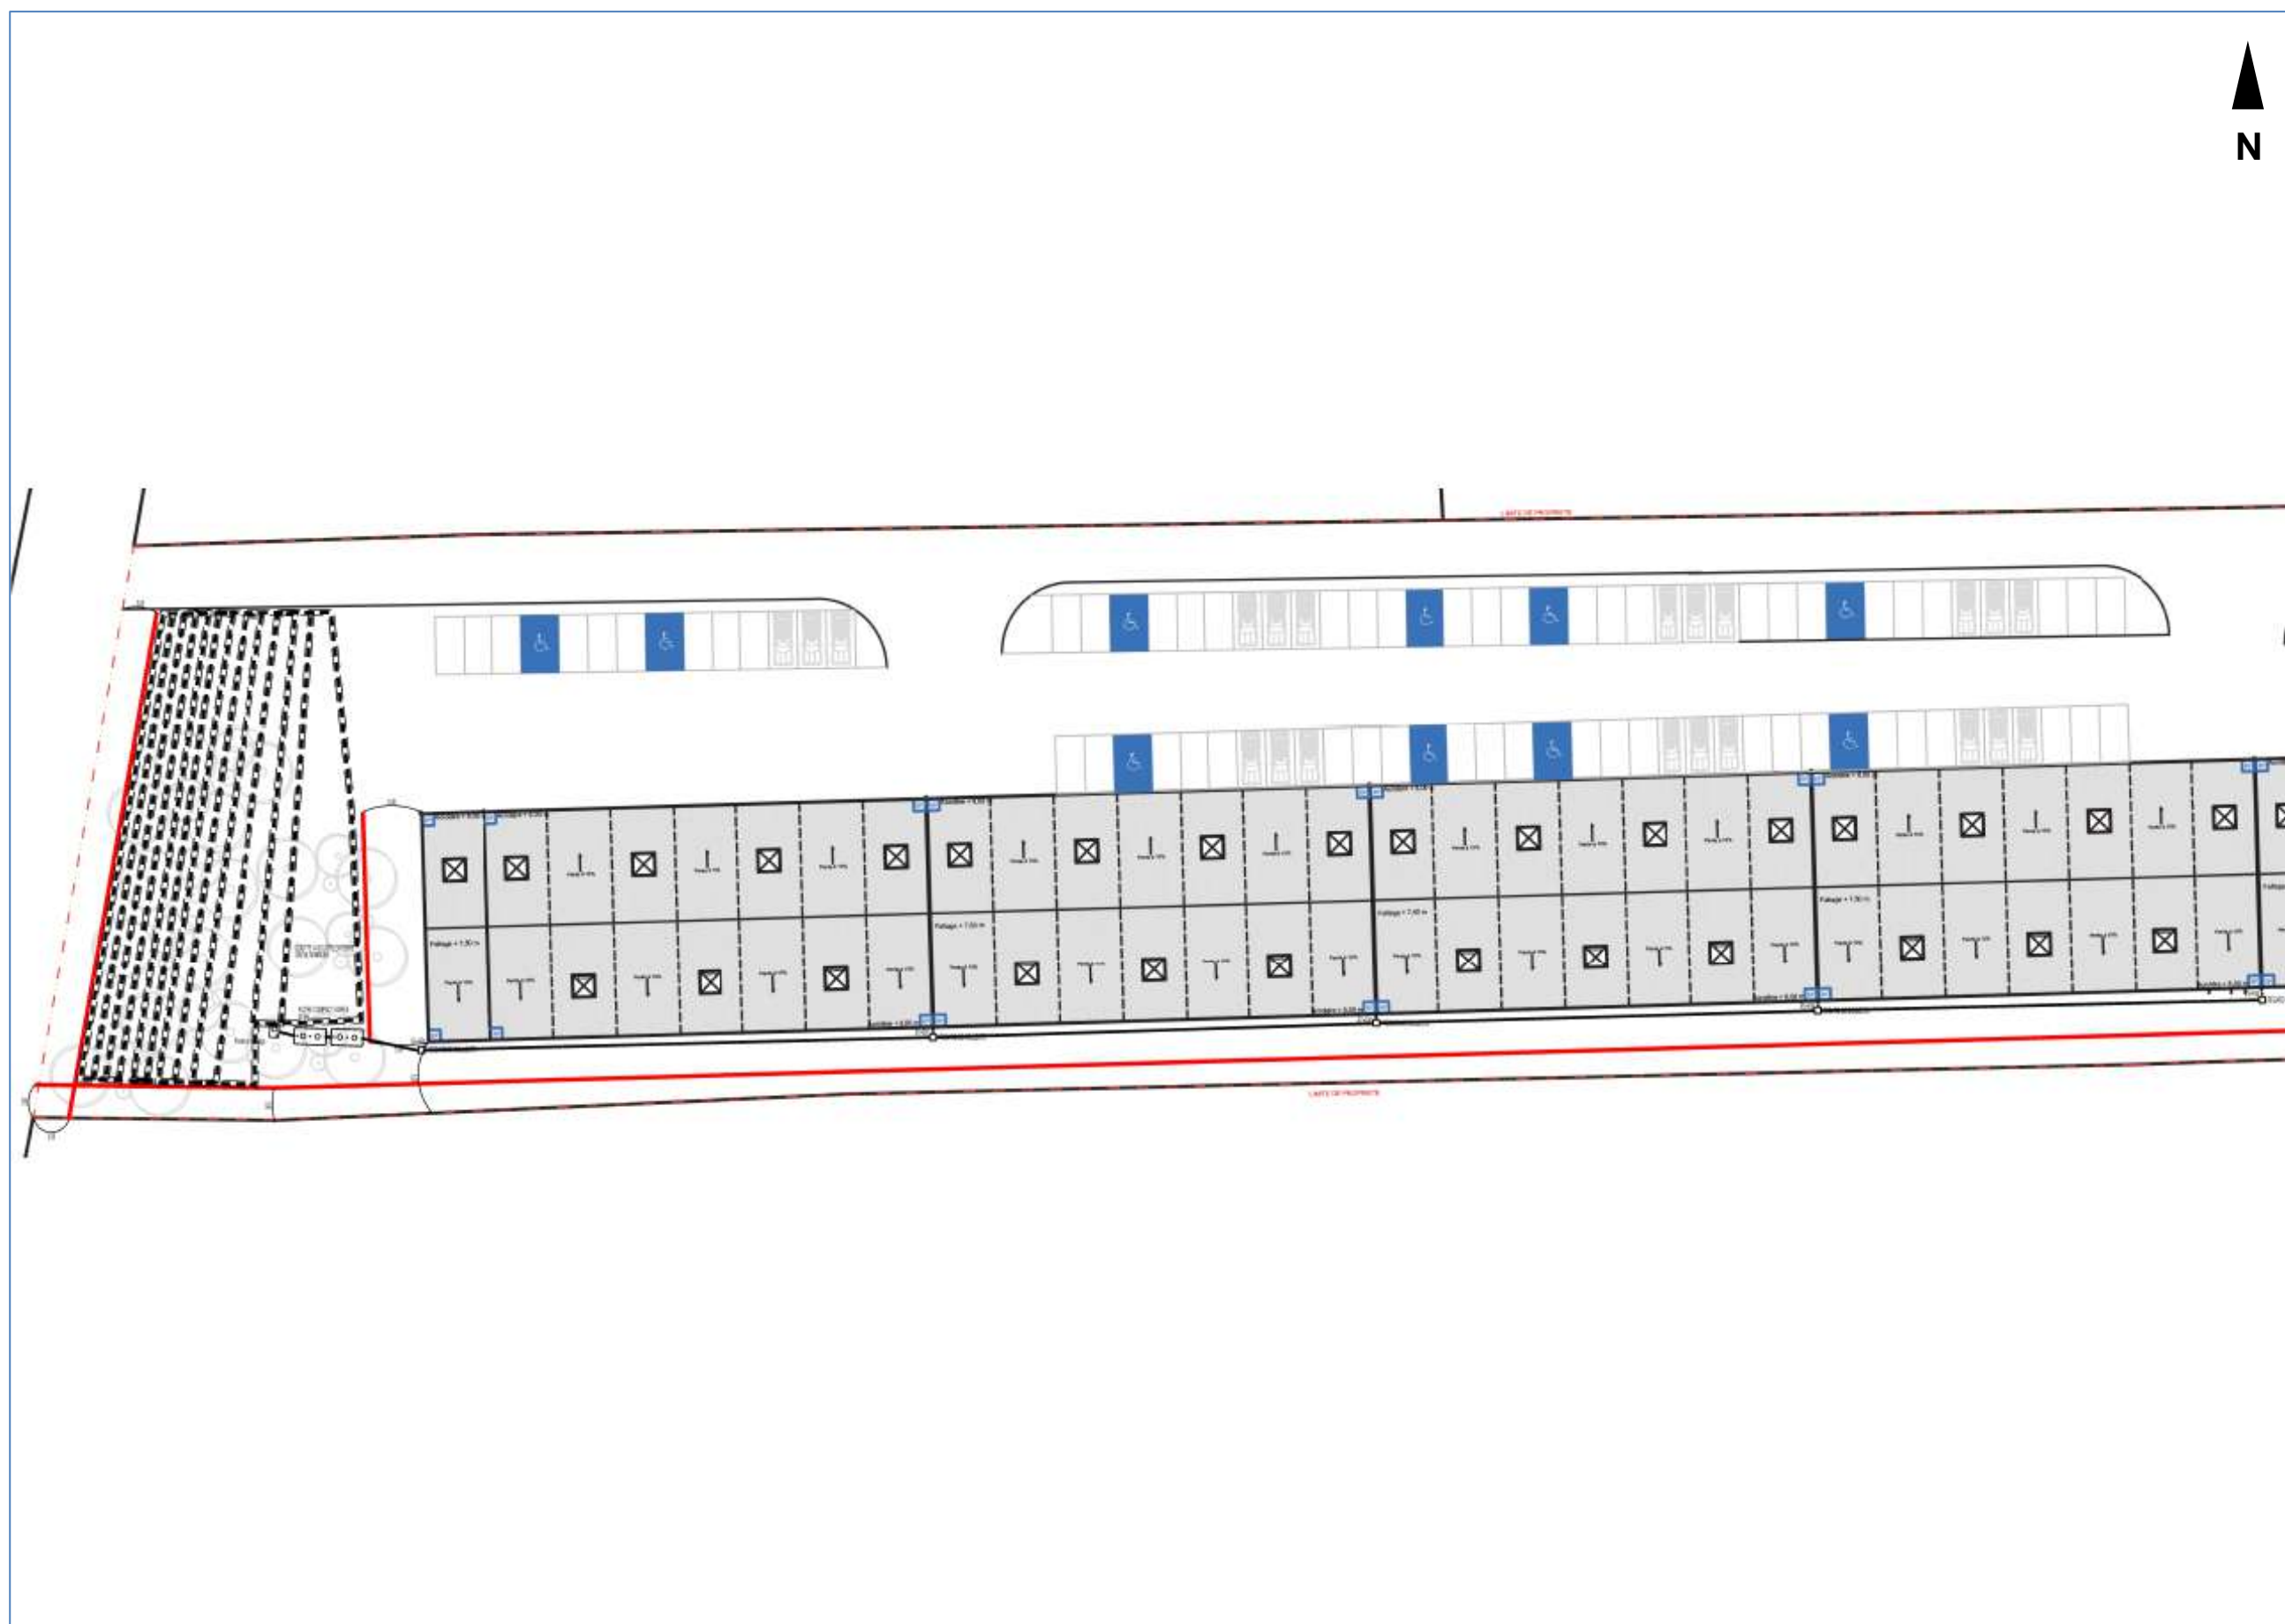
Mise en œuvre de l'assainissement par la filière compacte agréée – Plan de masse de l'installation projetée (zoom)
